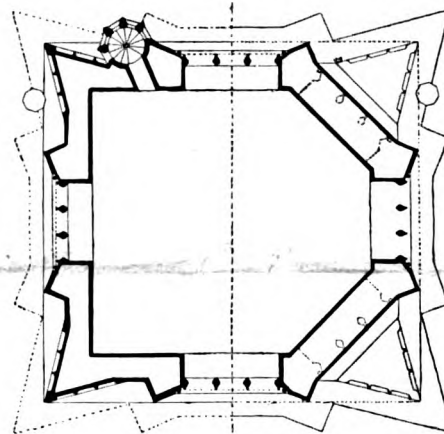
Grundriss des Vierecks im Achteck.
